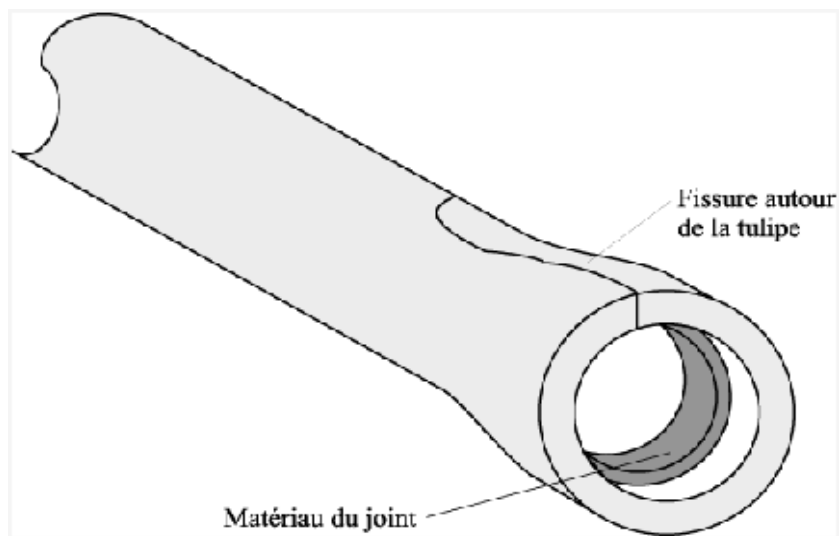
Différents types de ruptures des conduites d'eau potable (Fissure autour de la tulipe et joint)
